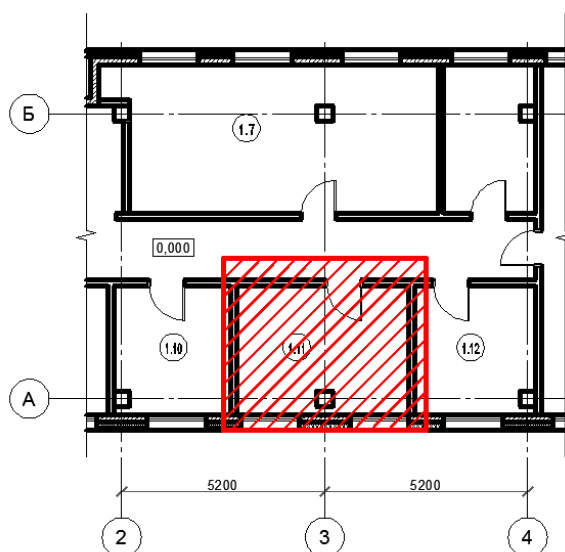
Грузовая площадь для сбора нагрузки на колонну.
